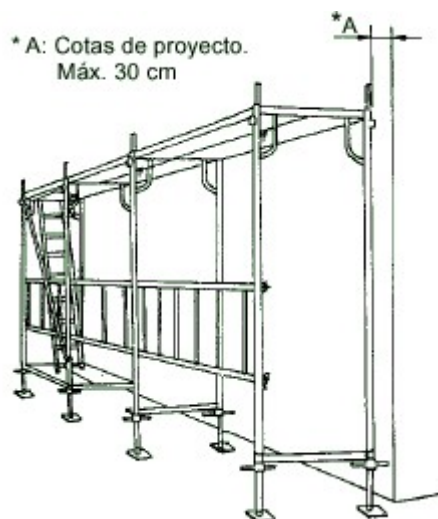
Encadenado del andamio y comprobación de la separación de la fachada
